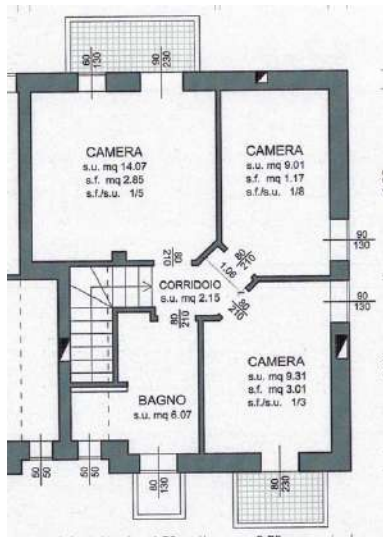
Comparazione stato approvato – stato rilevato (non in scala).
